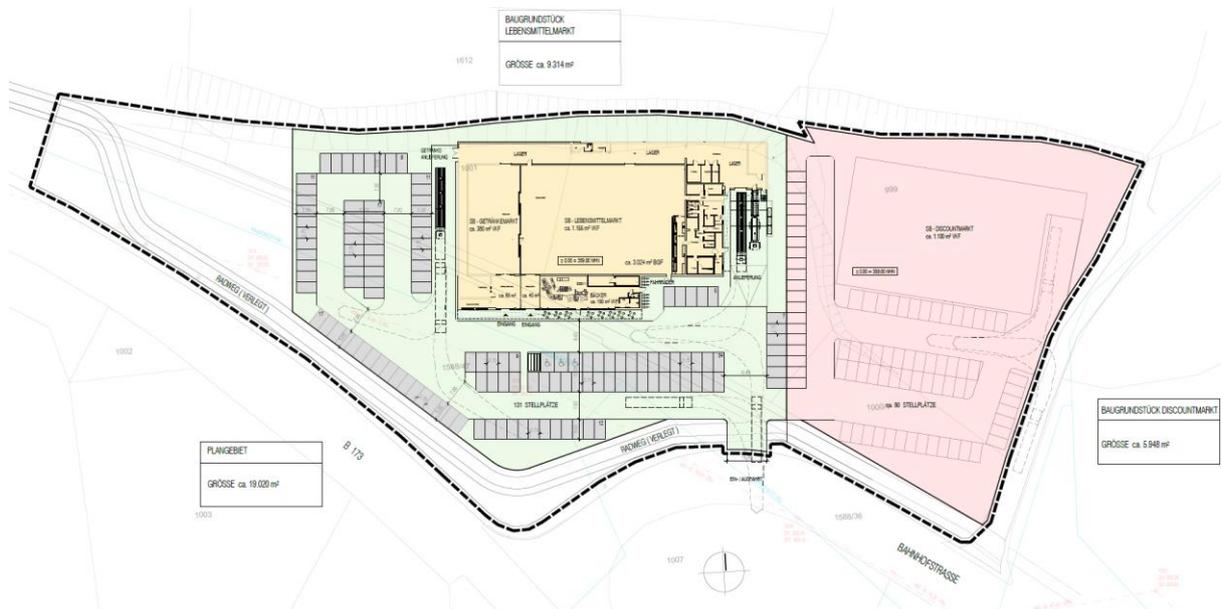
Vorhaben- und Erschließungsplan – Vorentwurf April 2024 – Lageplan (Plan genordet, unmaßstäblich) Quelle: Erhard Soyk, Dipl. Ing. Architekt, Detmold
